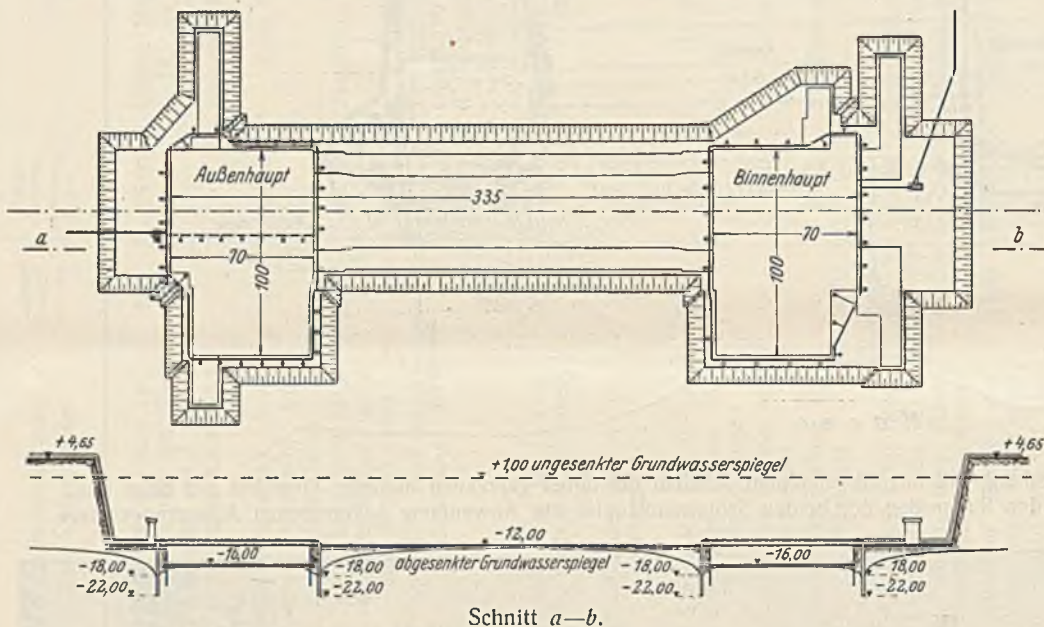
Beispiel einer Staffelsenkung in Verbindung mit offener Wasserhaltung: Grundriß und Längenschnitt der Grundwasserabsenkungsanlage beim Bau der neuen Seeschleuse am Kruisschans bei Antwerpen.
